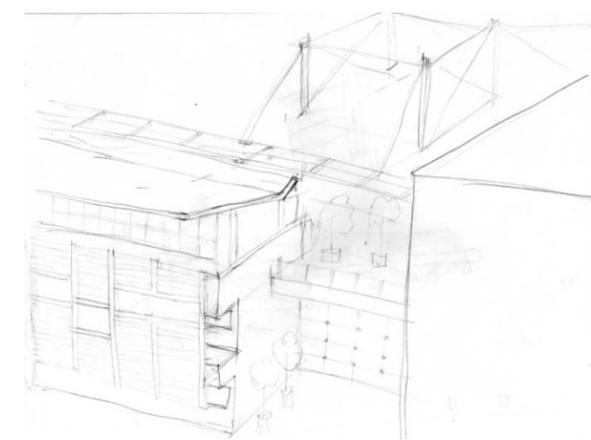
Boceto de propuesta de fachada del edificio de la División
